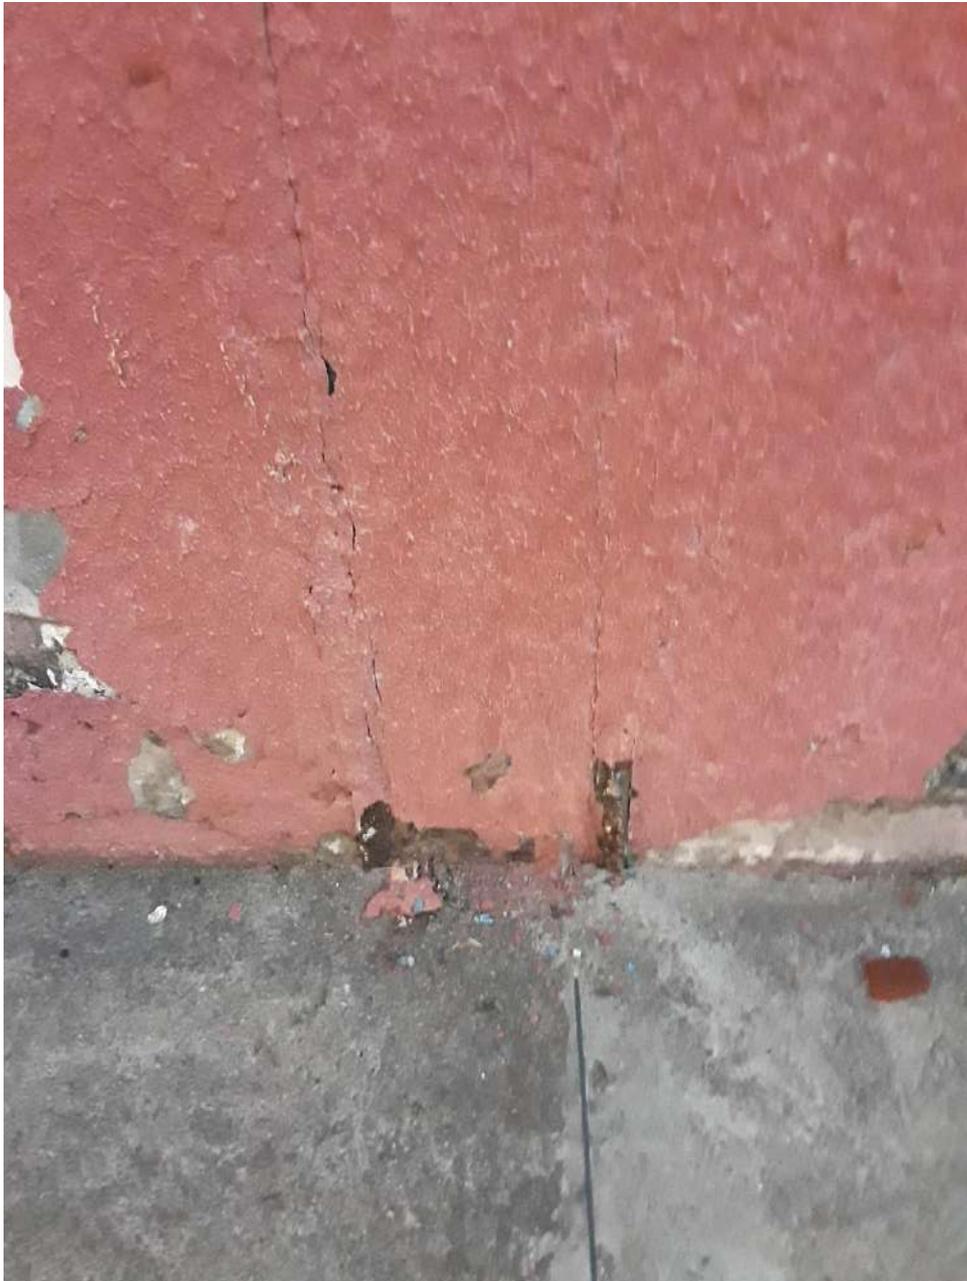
Base do Pilar 21 corrosão grau D
